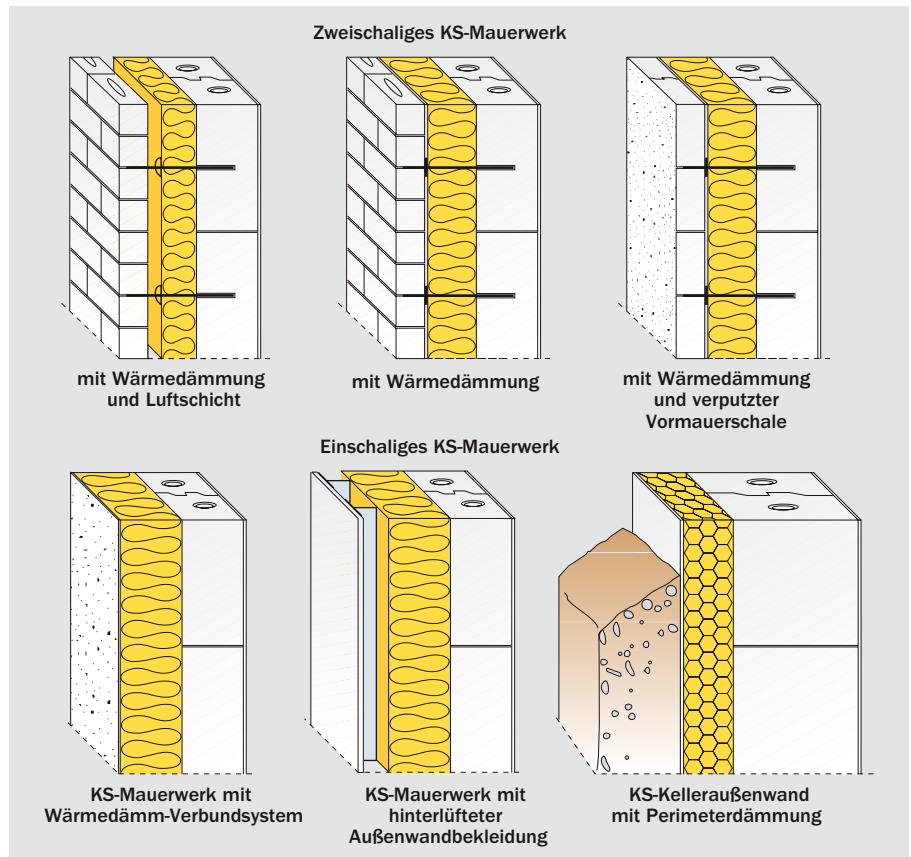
KS-Außenwandkonstruktionen für beheizte Gebäude
